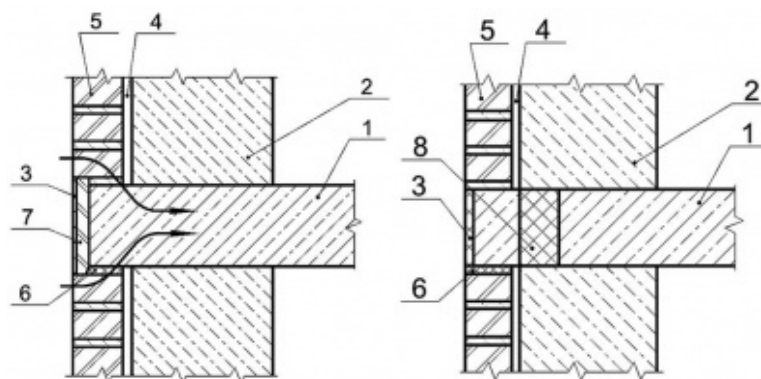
Варианты сопряжения лицевого слоя с плитой перекрытия:
